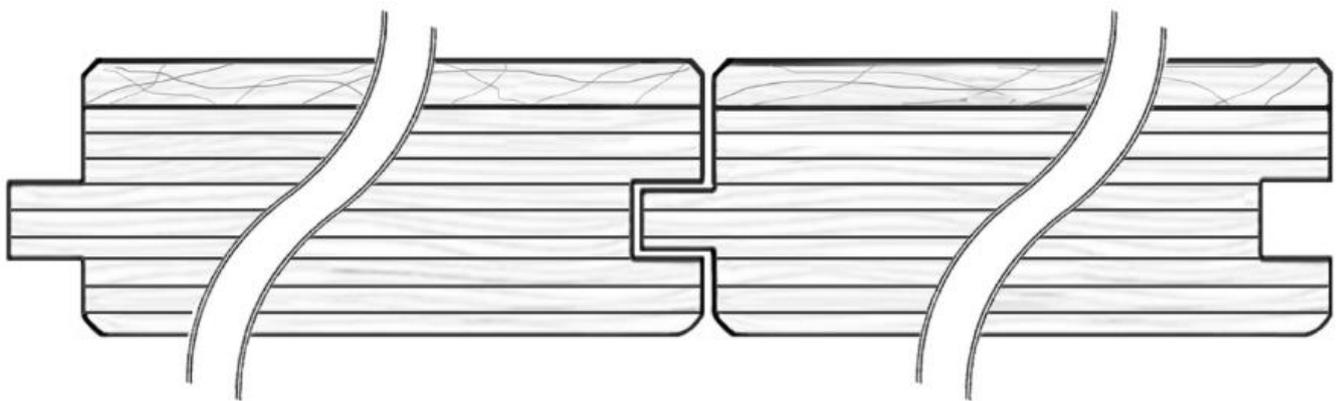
Конструкция изделия. Вид сбоку.
